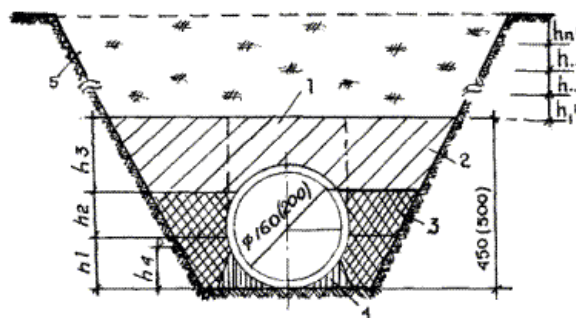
Схема уплотнения грунта при засыпке траншеи
